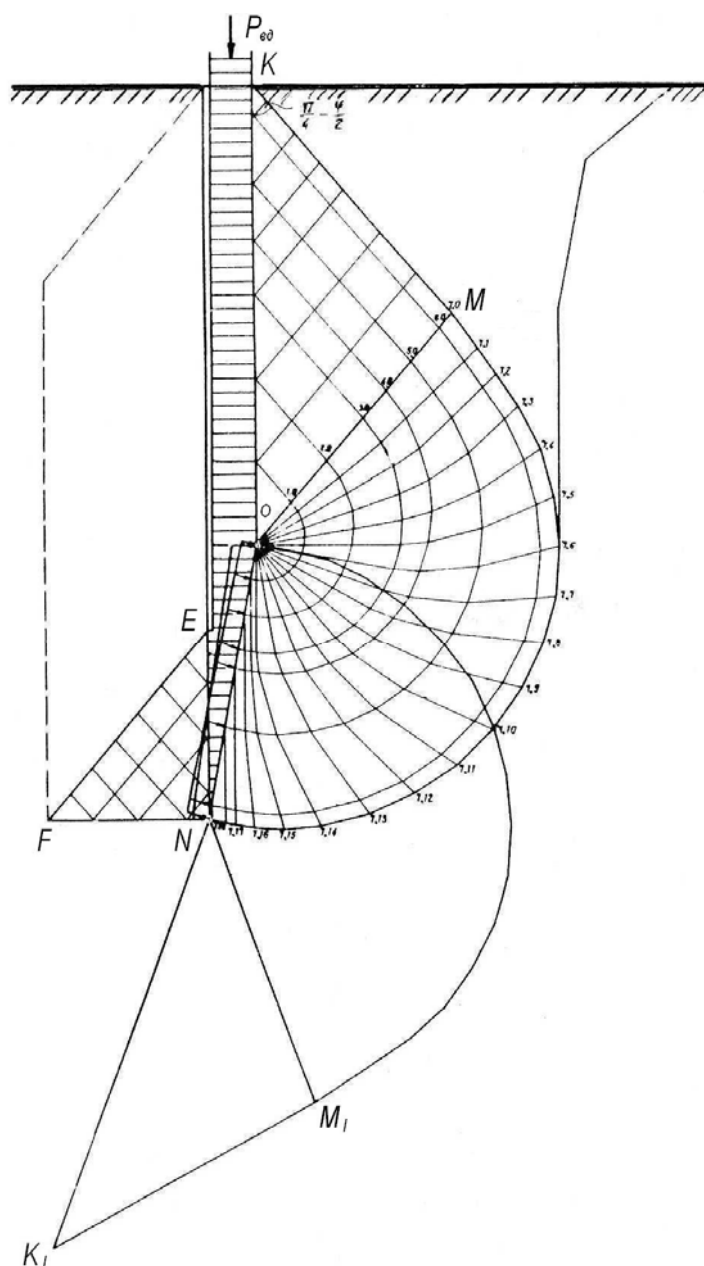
Схема развития областей нарушения грунта при вдавливании грунтоноса по А.В. Васильеву
